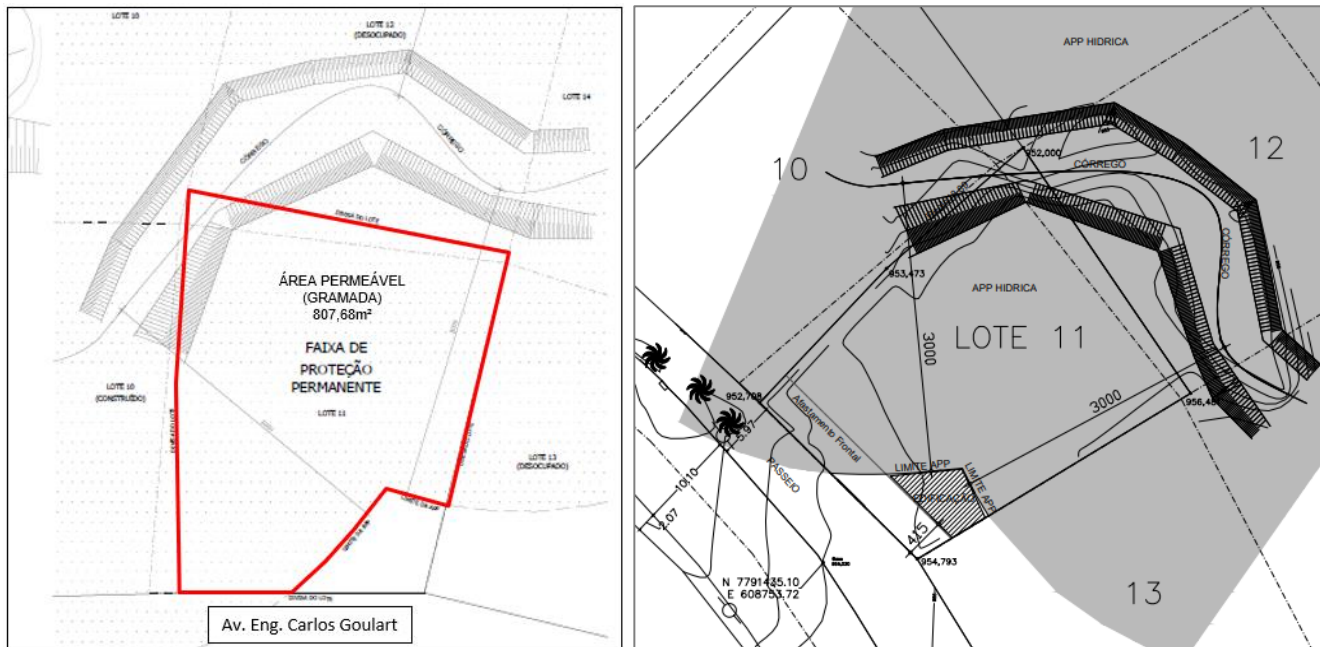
Planta de situação APP e área edificável - Fonte: Requerente/2023
